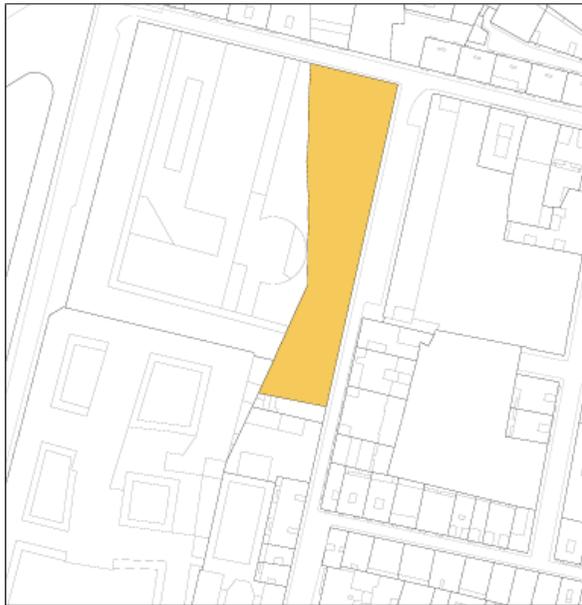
Plano del área a espaldas del IVAM con el solar actual.
